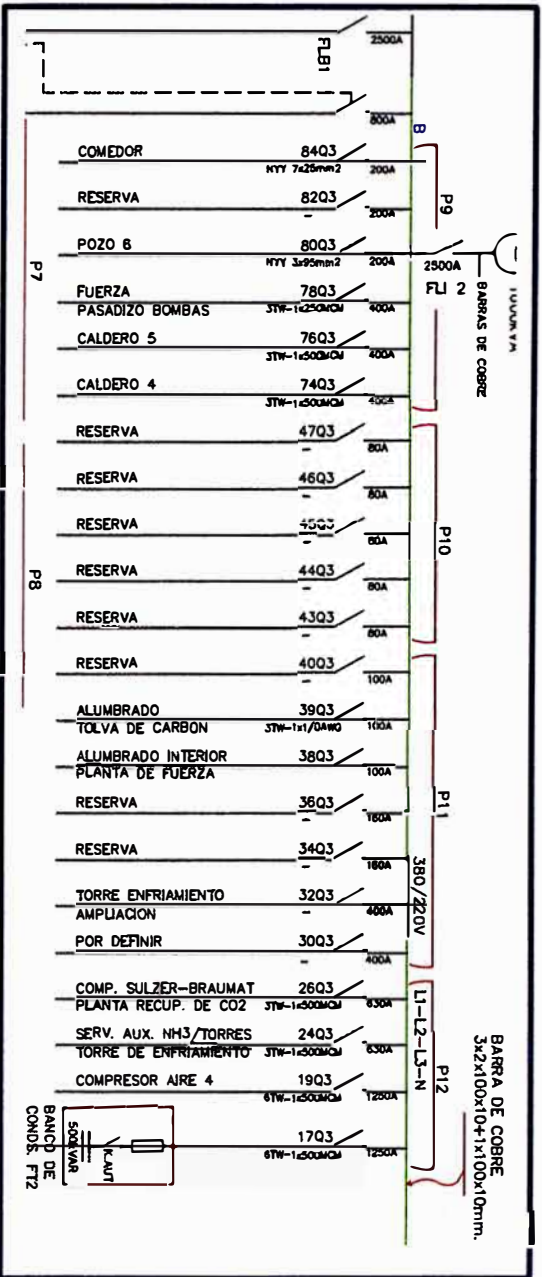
Subestación eléctrica F2 (Planta de Fuerza2) – Tablero 2
